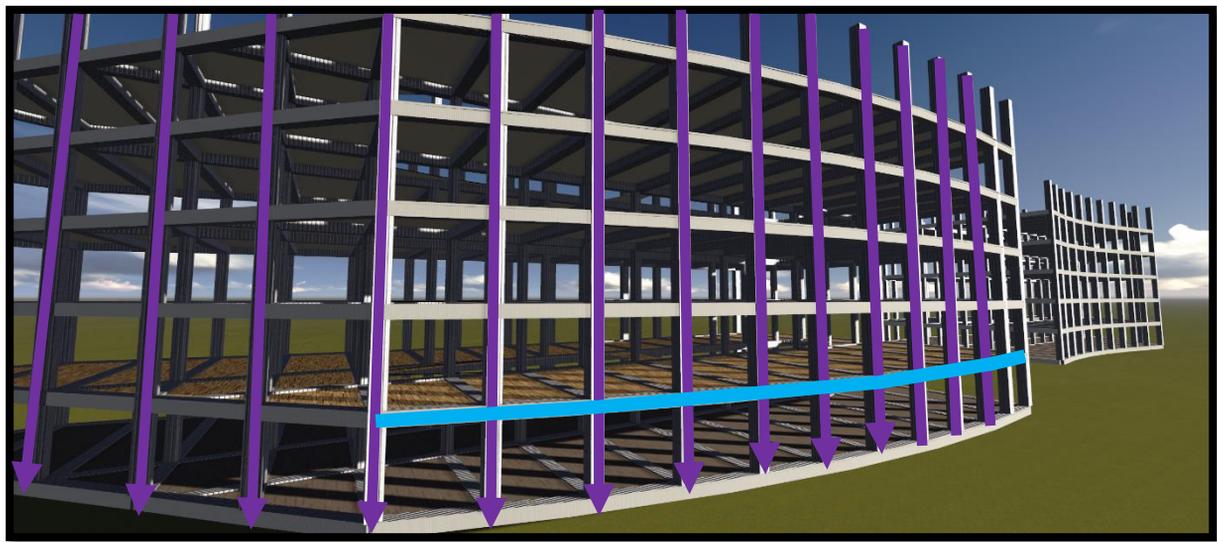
CHOIX DE LA STRUCTURE(SOCLE)
